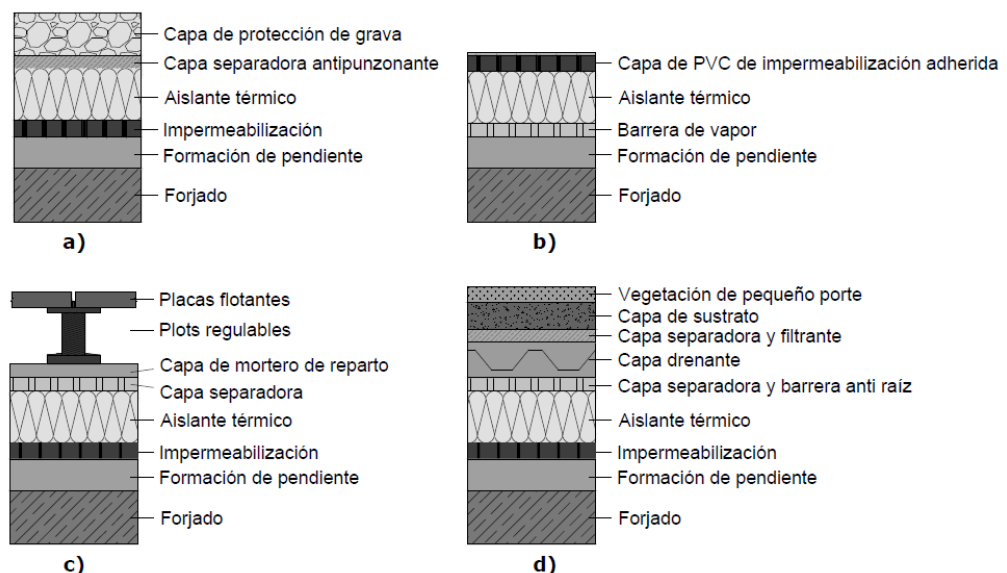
Secciones de cubiertas analizadas. a) Acabado de grava b) Autoprotegida c) Acabado de placas flotantes d) Ajardinada. Cross-sections of the proposed flat roofs. a) Gravel finishing roof b) Self-protected roof c) Floating flooring roof d) Green roof.
